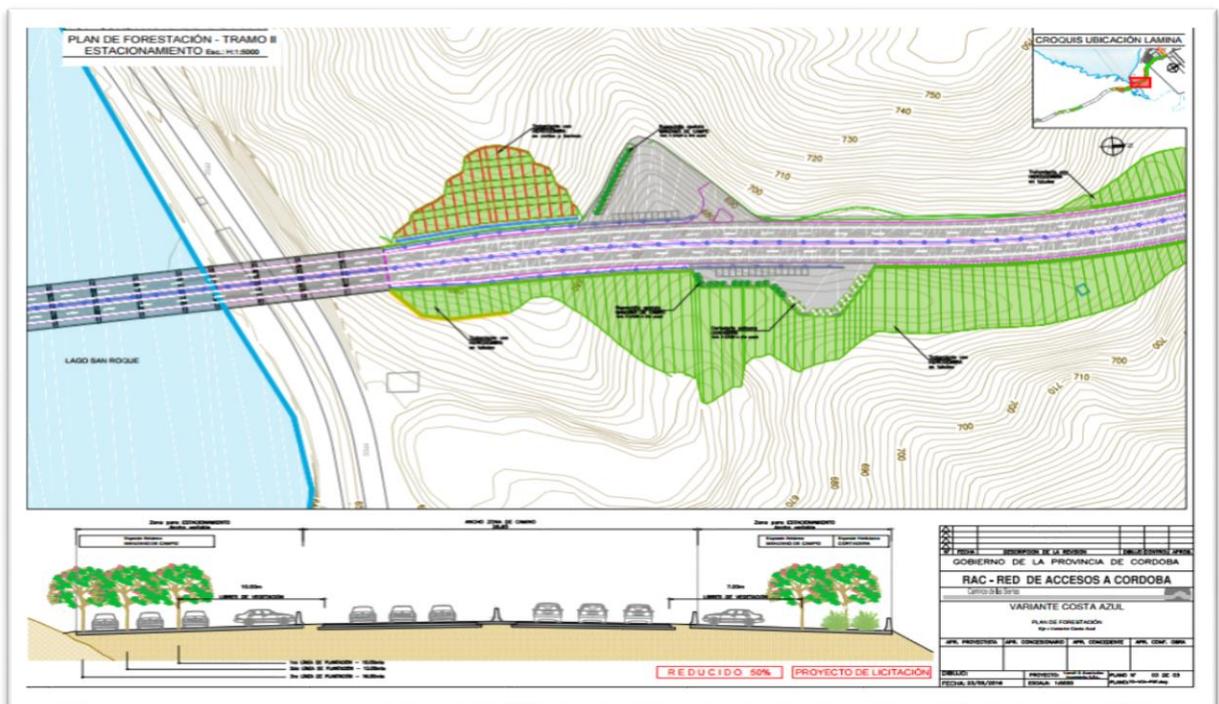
Plan de Forestación. Planimetría general y cortes de intervención paisajística y parquización de estacionamientos
